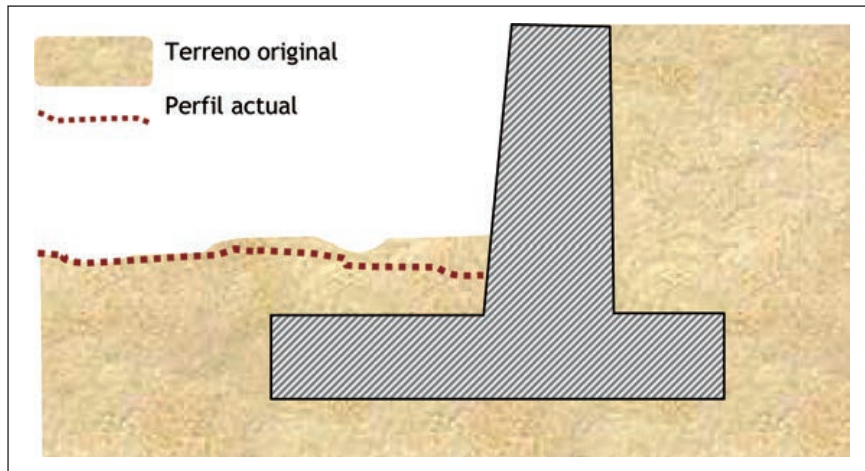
SOCAVACIÓN MODERADA EN ESTRIBO.
